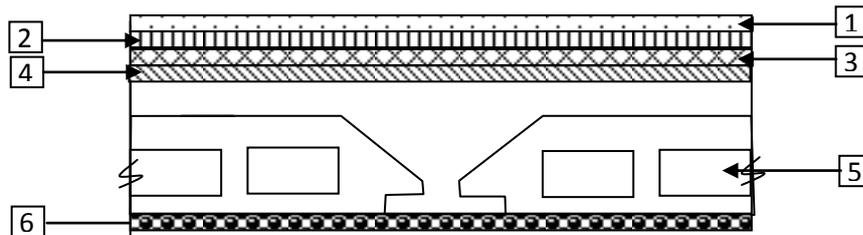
Coupe transversale d'un plancher terrasse inaccessible
